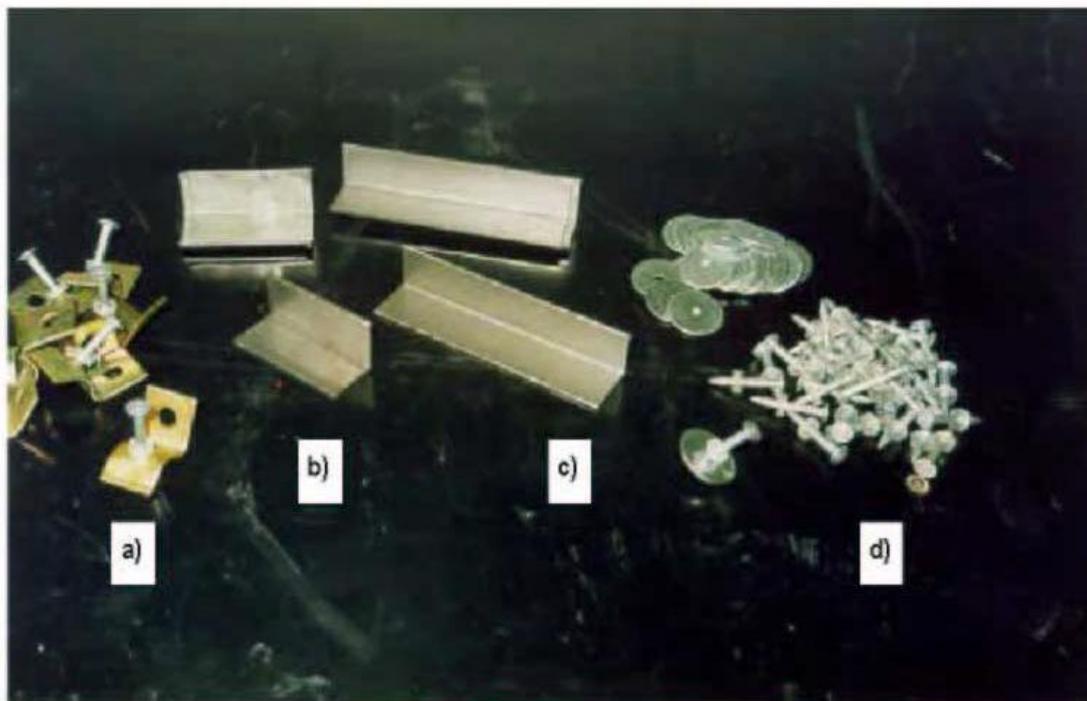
Componentes de fixação do material que liga alvenaria-pilar.
